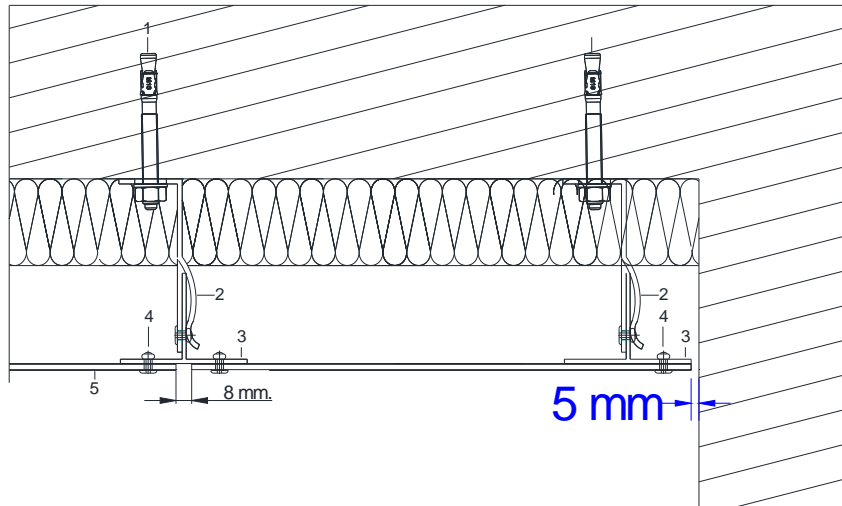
Arrêt latéral sur mur béton – Coupe horizontale
